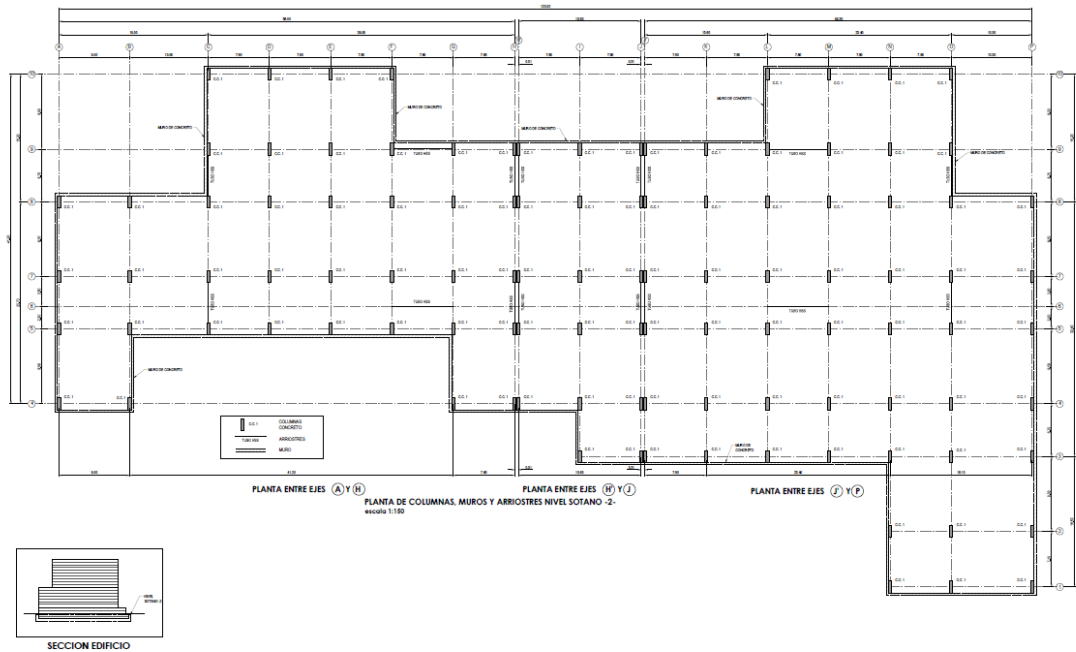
Planta Estructural Columnas, Muros y Arriostres. Sótano 2
